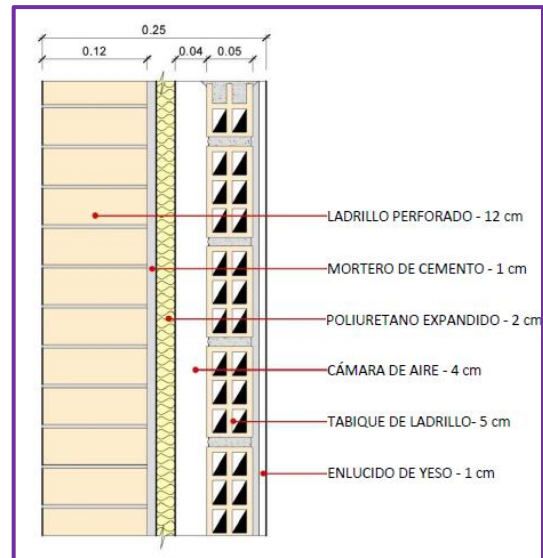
Detalle constructivo de muro cara vista
